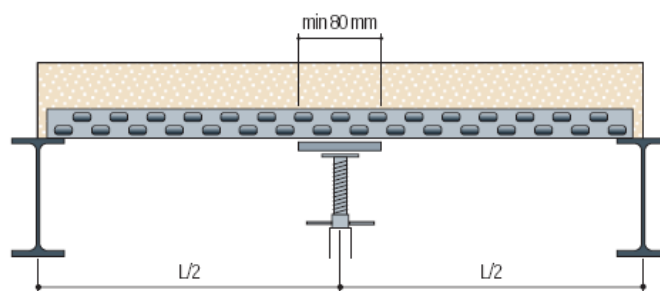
Detalle constructivo utilizando puntales (tomada de [10])
